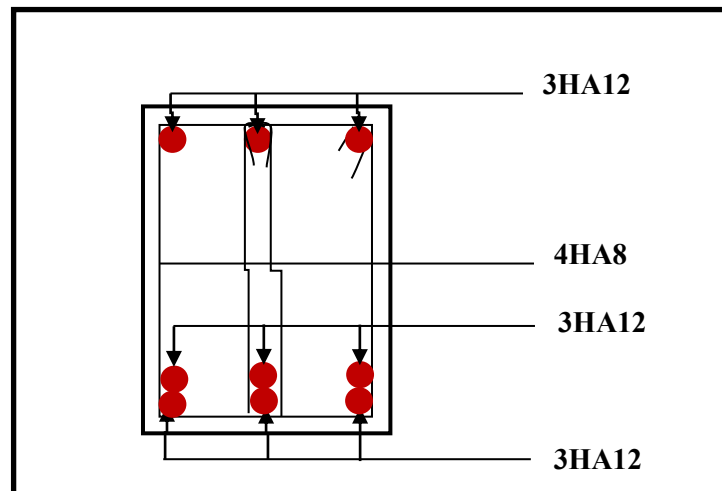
Ferrailage en travée d'une poutre secondaire.
